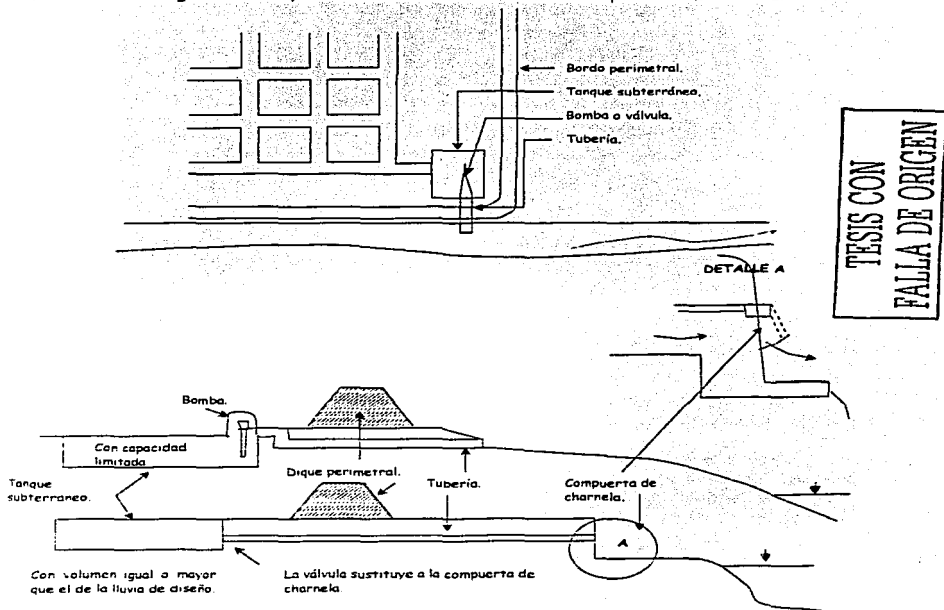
Drenaje de las Áreas Protegidas con Bordos Perimetrales.
